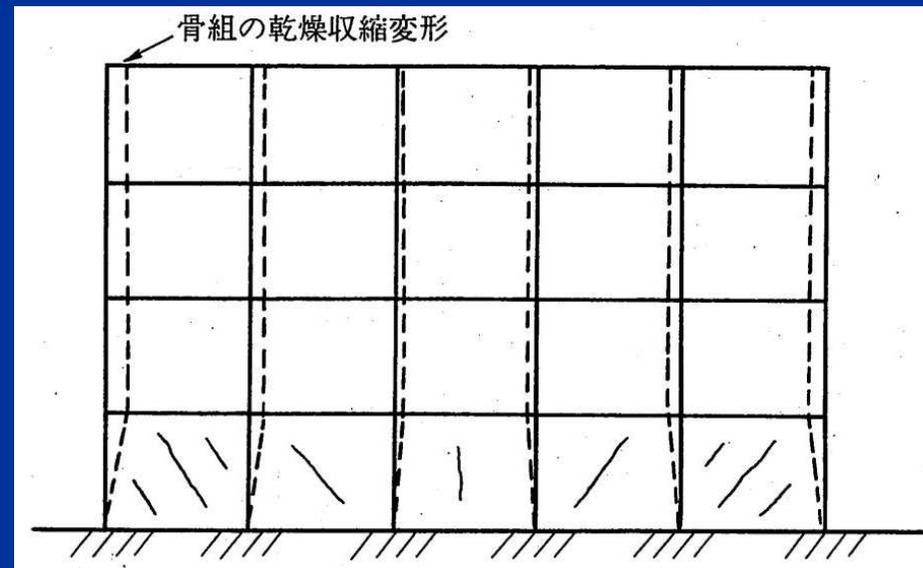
骨組の乾燥収縮による変形と壁のひび割れ
